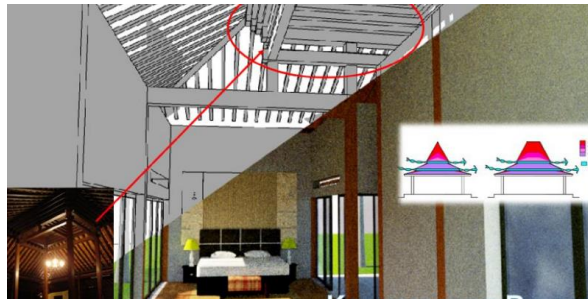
Filosofi bangunan tradisional Jawa
